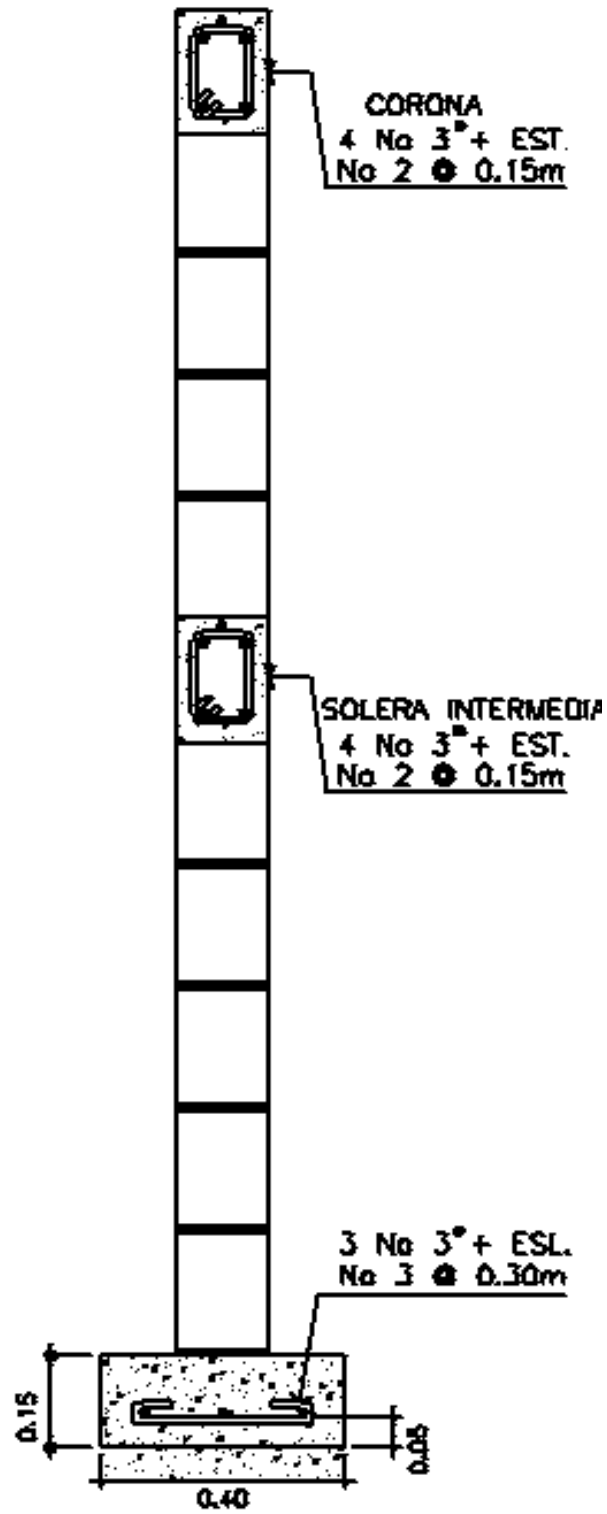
Detalle 1 de armado de columnas de muro con solera.
